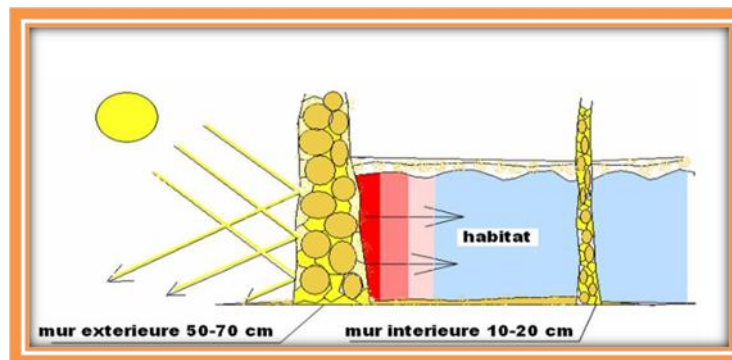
Coupe schématique sur un mur en pierre aux Tafilalet
